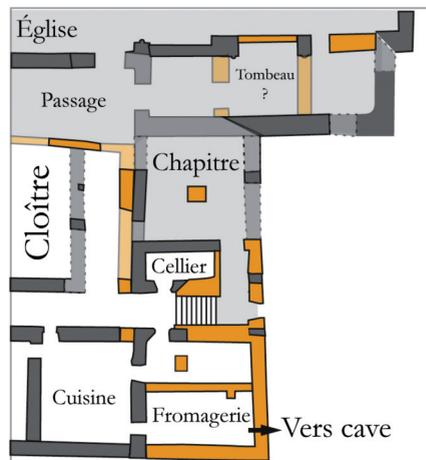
Évolution architecturale du rez-de-chaussée du tiers oriental de l'abbaye
